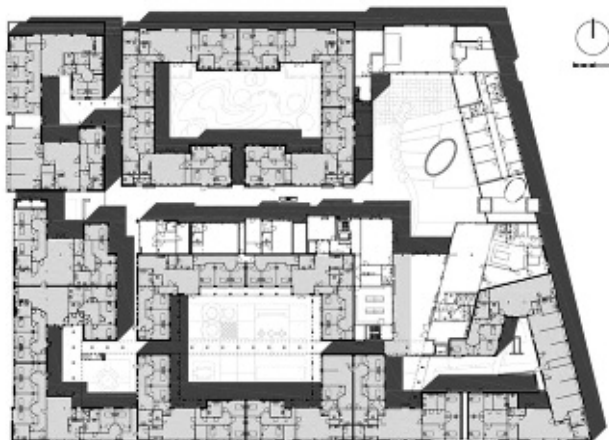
Hogeweyk. <https://www.nortehispana.com/blog/hogeweyk-ciudad-enfermos-alzheimer/>
